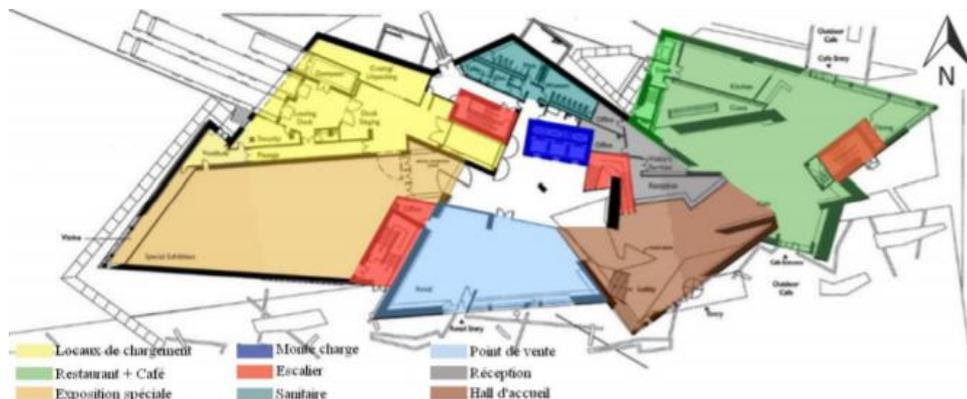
Plan RDC. Source : www.archdaily.com, édité par l'auteur
